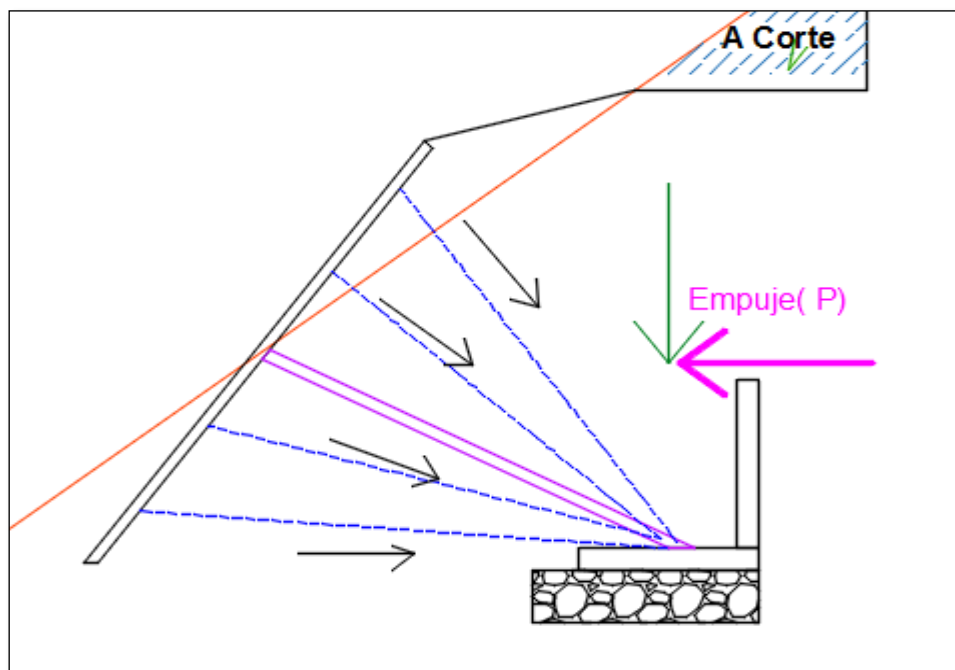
Empuje aplicado en el Panel del Sistema Erdox
